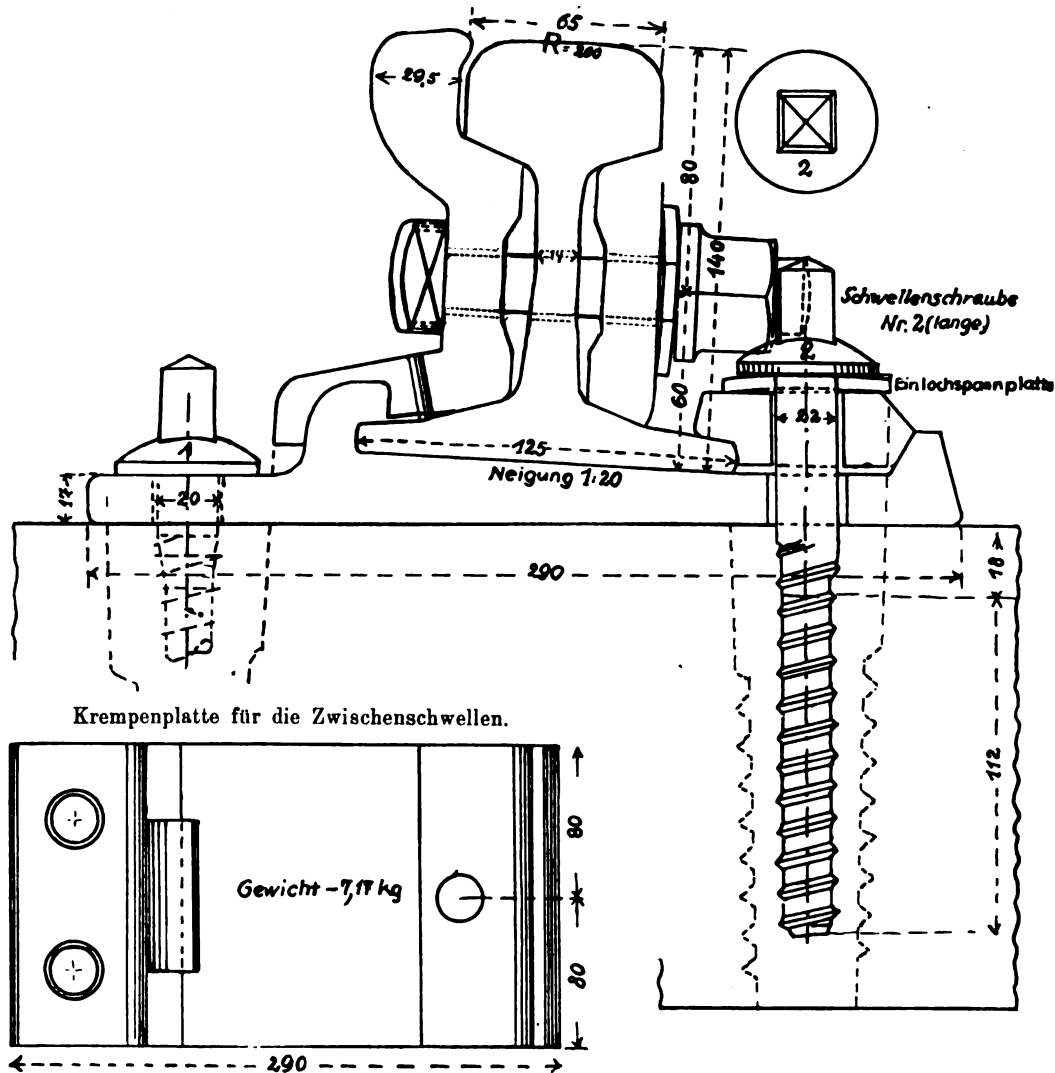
E Profil Oberbau auf Holzschwellen mit Auflaufaschen und Stofabrücken am Schienenstofs; Bauart 1908.
